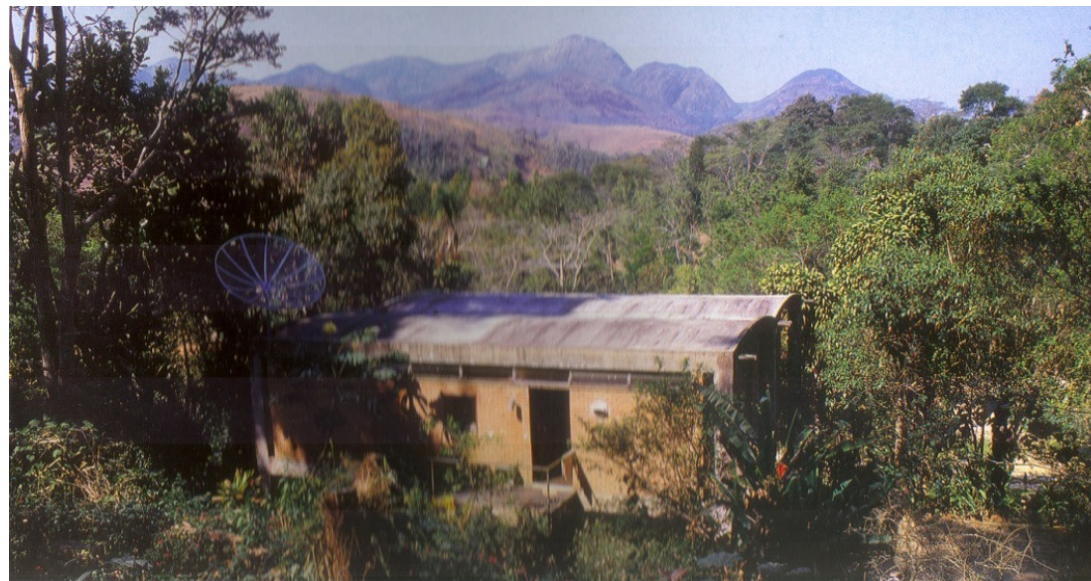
Fachada Sudoeste com vista parcial da laje nervurada.
